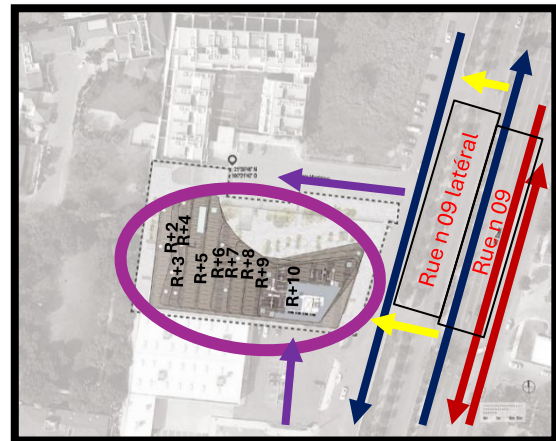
plan de masse source : www.archdaily.com traite par les auteurs
